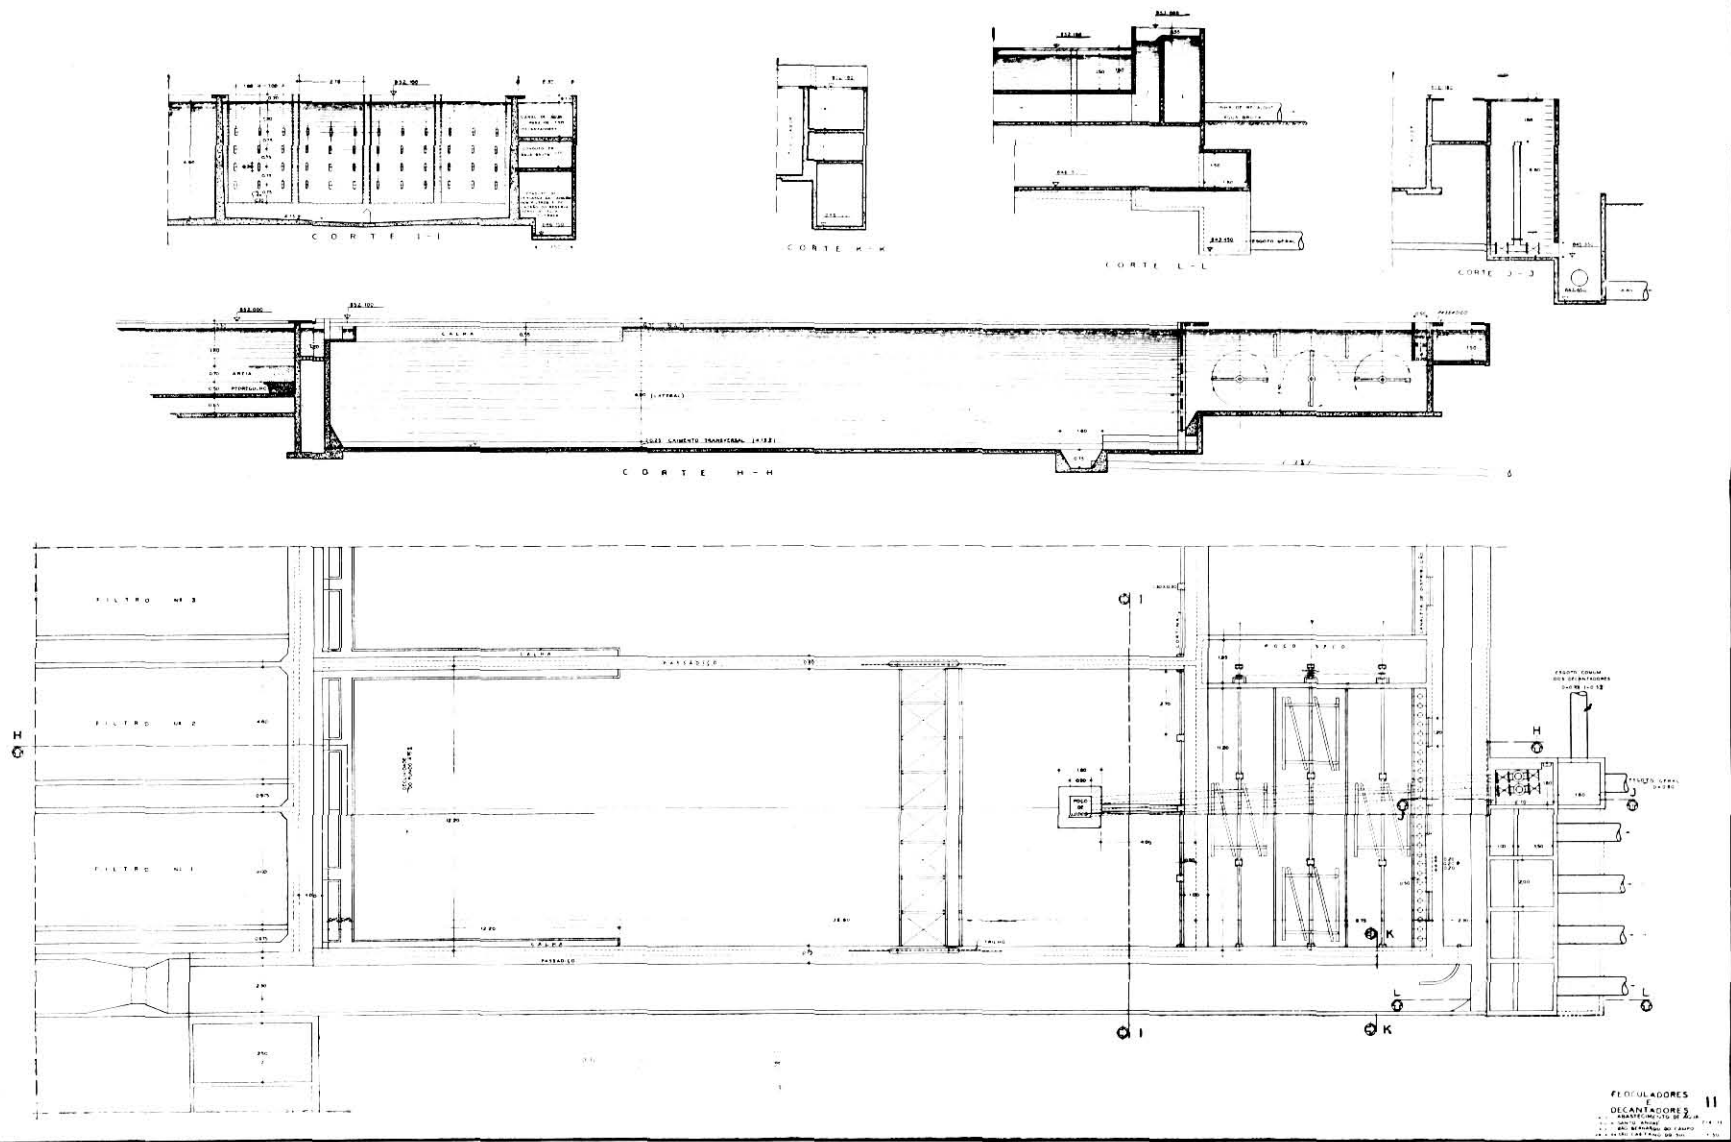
Floculadores e Decantadores (Nota: as cotas e alguns detalhes construtivos foram alterados durante a construção).
